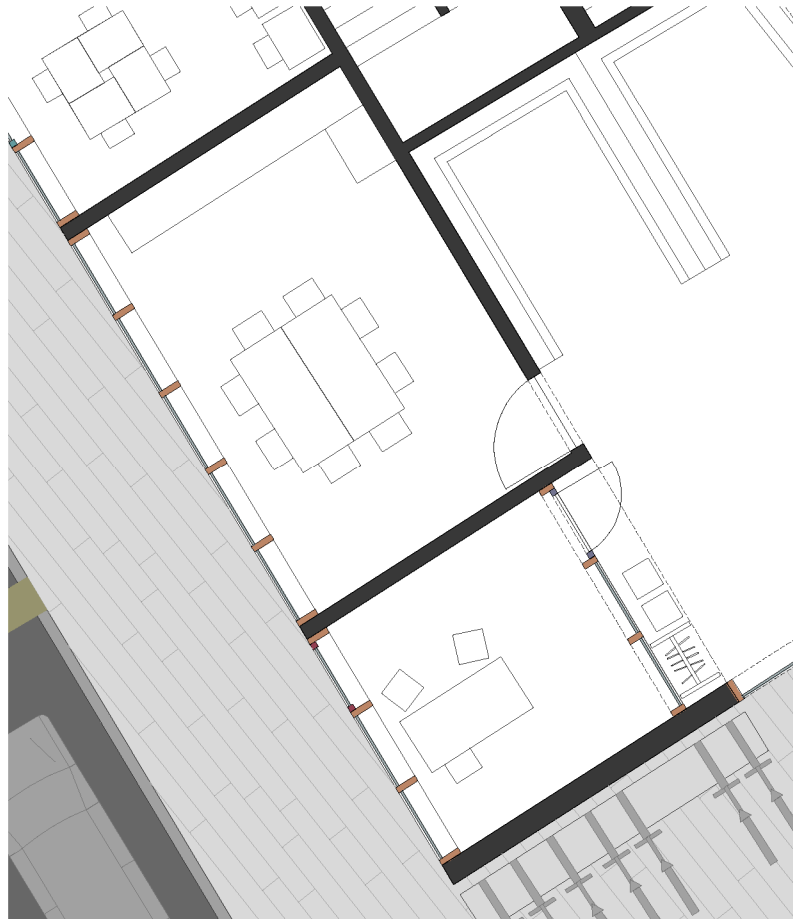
Grundriss Büro und Personalraum 1:100
